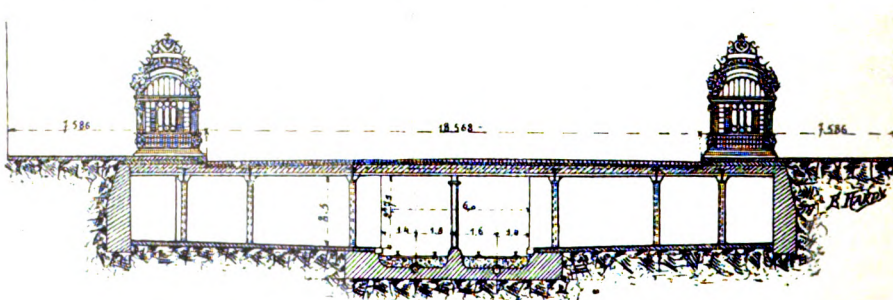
Coupe en travers de la station III : Vazikurut.
